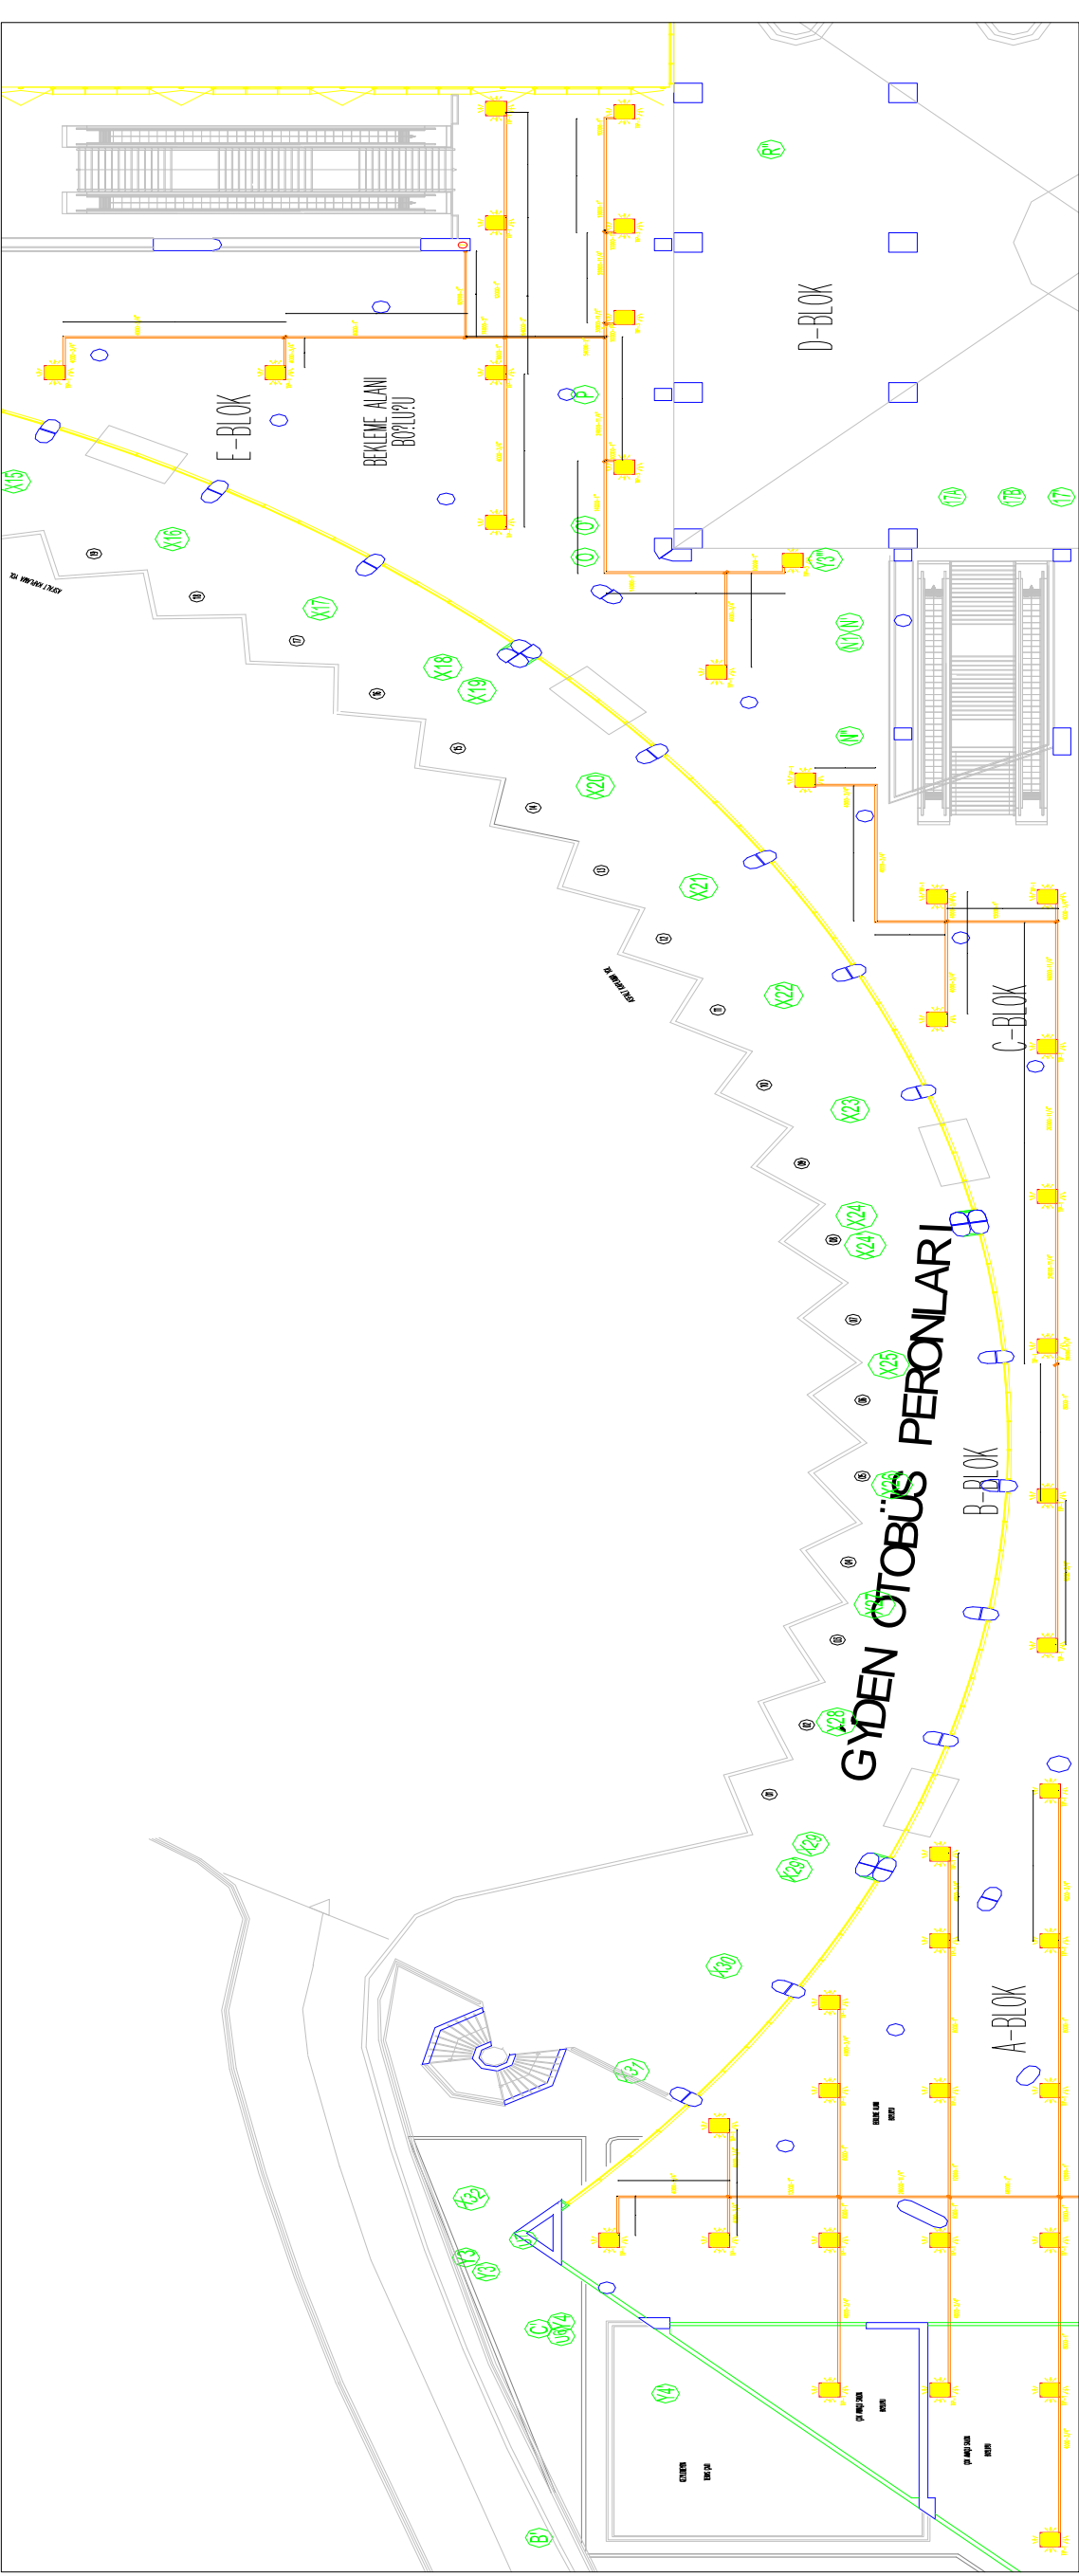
Örnek binadaki ısıtma tesisatı boruları
